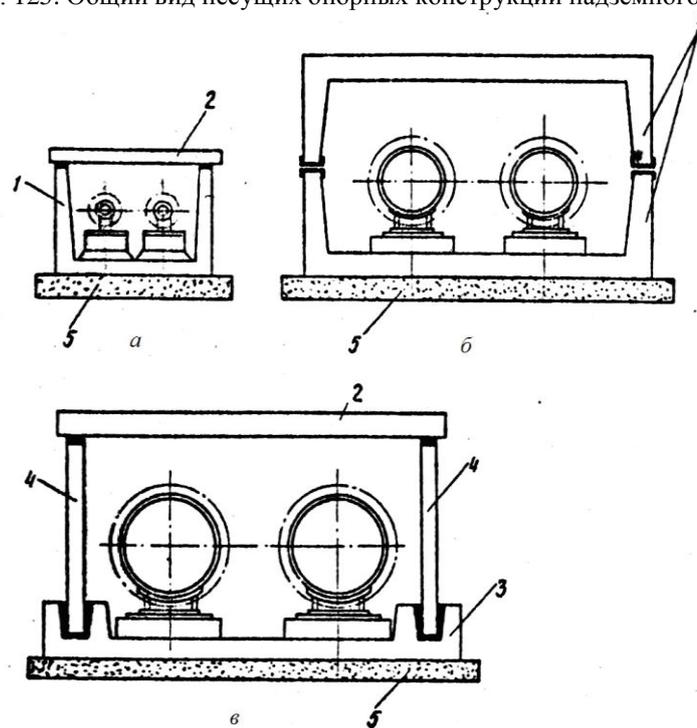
Унифицированные сборные железобетонные непроходные каналы: *а* — для труб малых диаметров; *б* — то же, для средних; *в* — то же, для крупных; 1 — железобетонный лоток; 2 — железобетонная плита перекрытия; 3 — плита днища марки; 4 — стенная плита; 5 — песчаная подготовка
